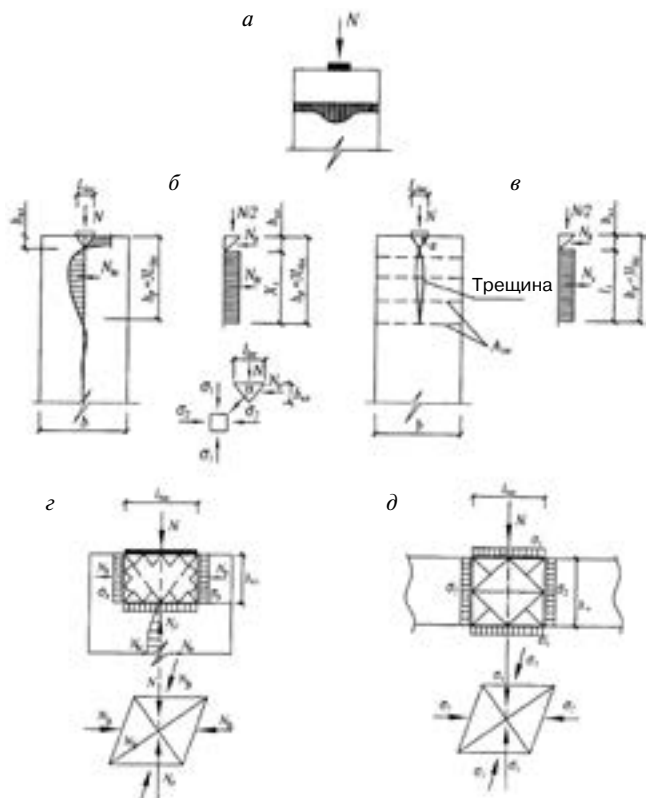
Расчетные схемы стыка при действии монтажных нагрузок при стальной центрирующей прокладке: а – общий вид стыка; б–г – при расчете оголовка нижней и верхней колонн; д – для опорной зоны плит между центрирующими прокладками
